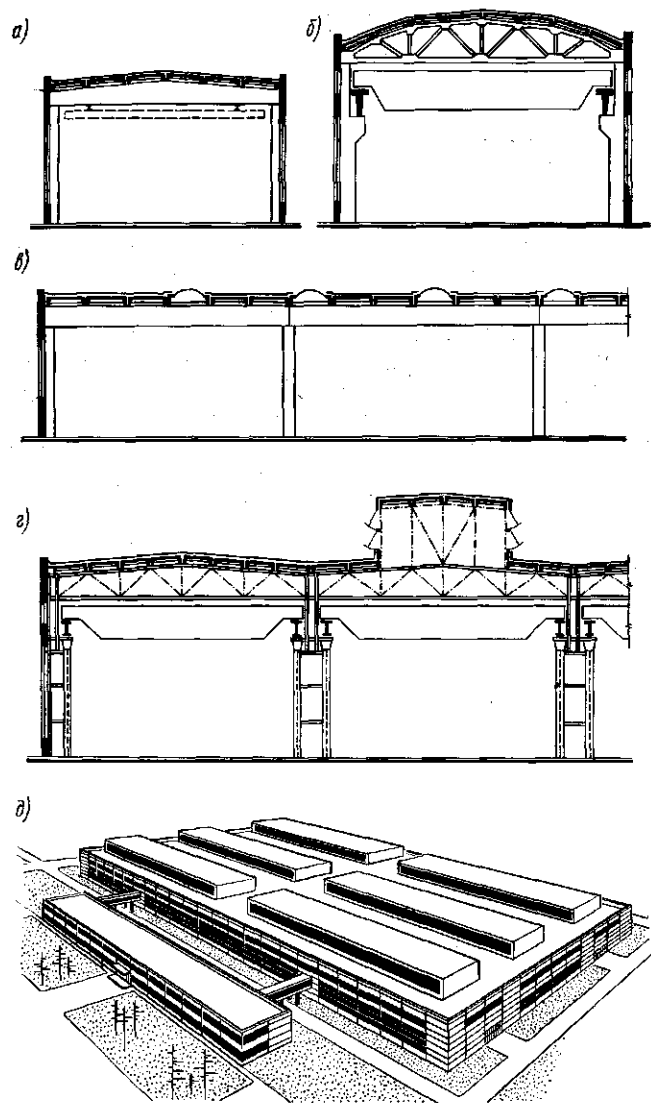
Основные типы одноэтажных промышленных зданий: а — однопролетное бесфонарное; б — то же, с мостовым краном; в, г — многопролетные с фонарями; д — общий вид здания
